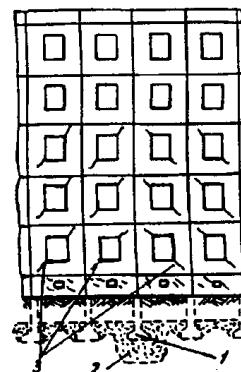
Схема деформации крупнопанельного дома из-за локальной неоднородности грунтового основания:
